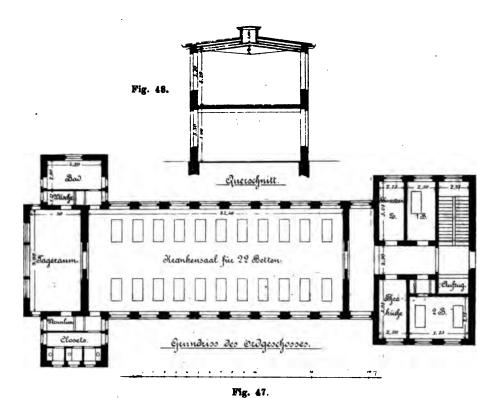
Zweigeschossiger Pavillon des Krankenhauses a. d. Strangriede in Hannover. Fig. 48. Querschnitt.
